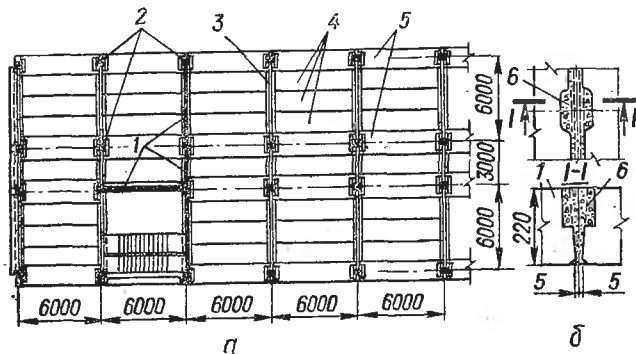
Перекрытия в зданиях с унифицированным каркасом:
